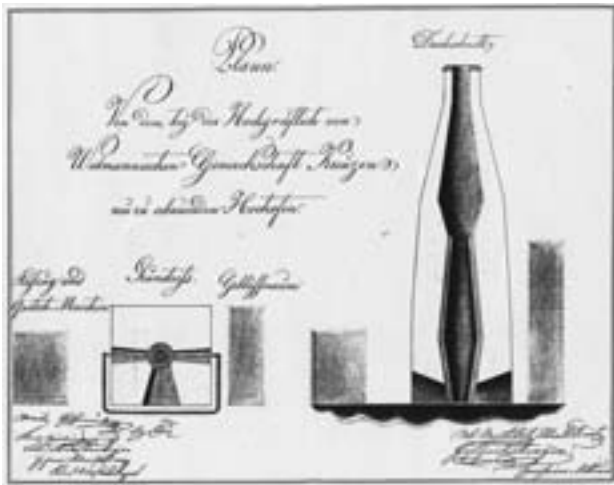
Bauplan des 1840 erbauten und am 6. Jänner 1841 angeblasenen Hochofens der „Hochgräflich von Widmannischen Gewerkschaft“ in der Kreuzen. Kärntner Landesarchiv Klagenfurt. Kreisamt Villach, Fasz. 540: Undatierter Bauplan bei dem mit 24. März 1840 datierten Gesuch der Graf Widmann'schen Werksdirektion in Paternion um Baugenehmigung.
